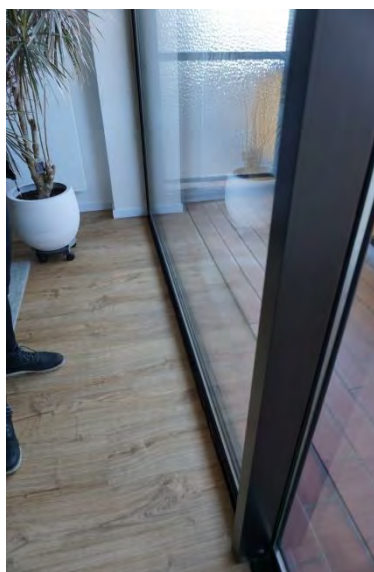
Origineel niet-thermisch onderbroken schrijnwerk, met originele dubbele beglazing
